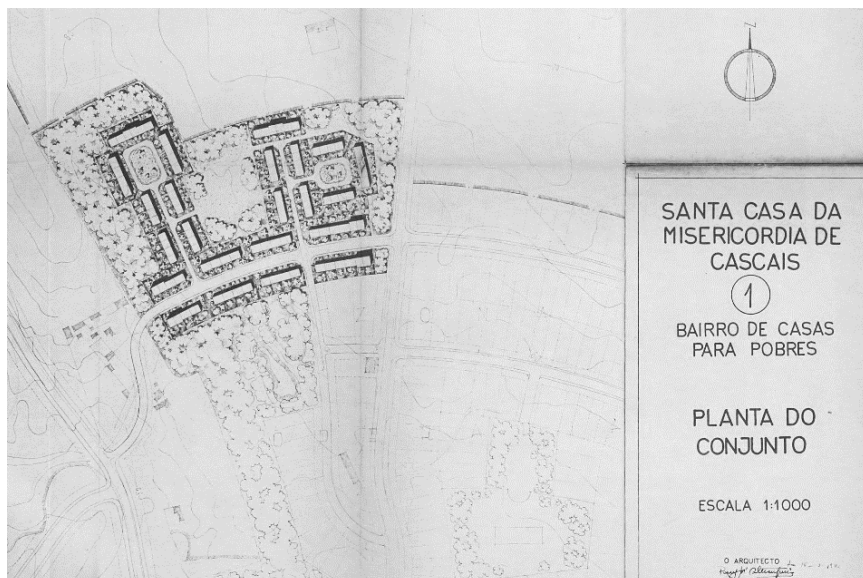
Planta do Conjunto da Primeira fase do Bairro Marechal Carmona | Arquivo Municipal de Lisboa.
